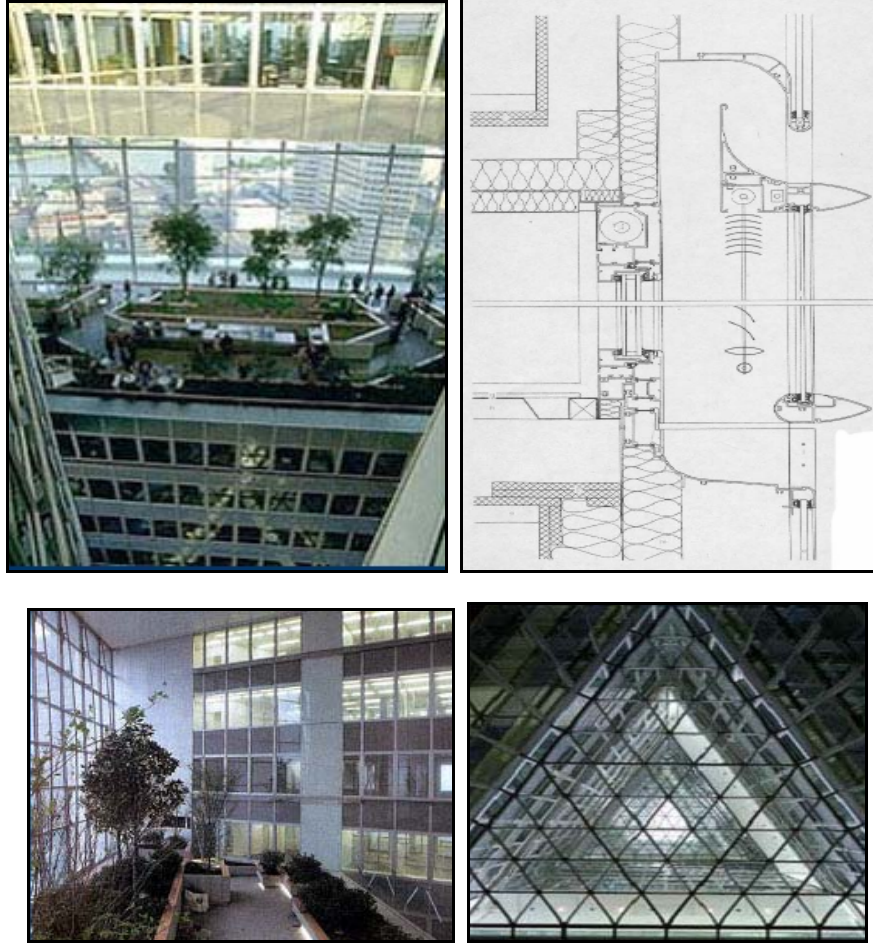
Commerzbank Merkez Binası plan kesit ve görünüşü [32]
